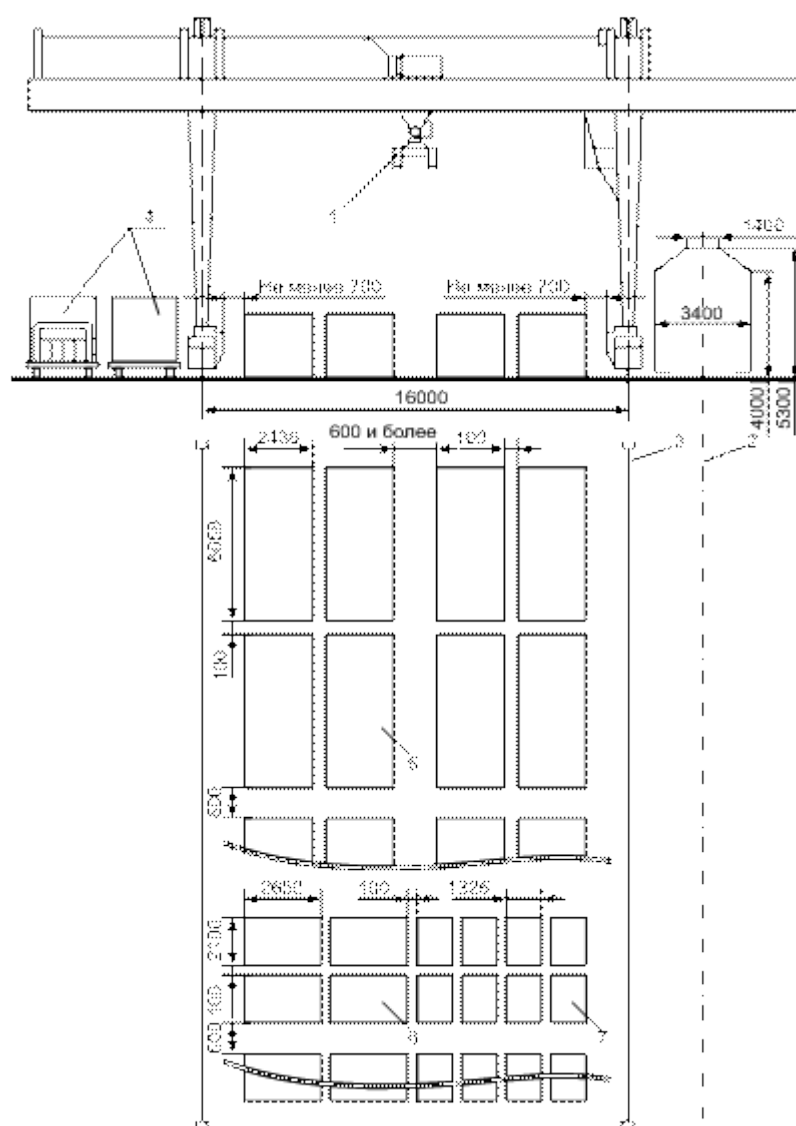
Схема размещения контейнеров на совмещенной контейнерной площадке для переработки крупнотоннажных и среднетоннажных контейнеров, обслуживаемой козловым краном пролетом 16 м со сменными захватами: 1 – механизм подъема или опускания груза; 2 – ось железнодорожного пути; 3 – подкрановые пути; 4 – автомобили для завоза–вывоза контейнеров; 5 – контейнеры 1С
